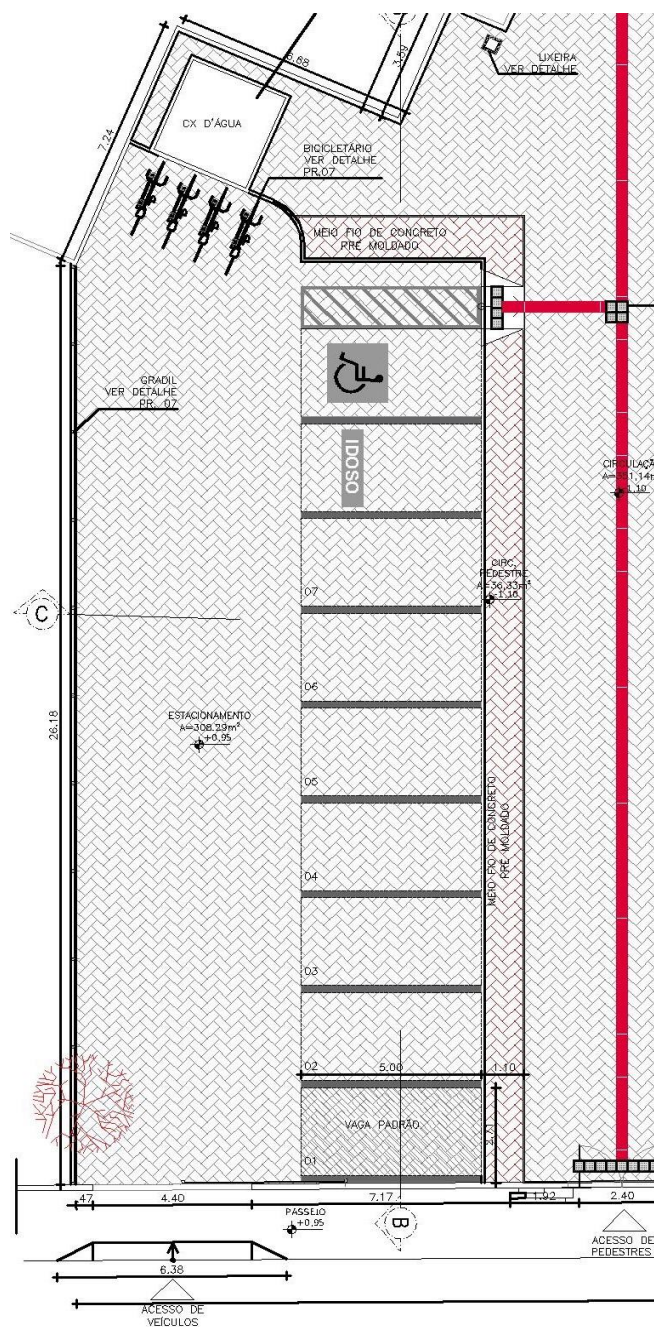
Planta de Implantação. Fonte: SEINF-COPROJ.
